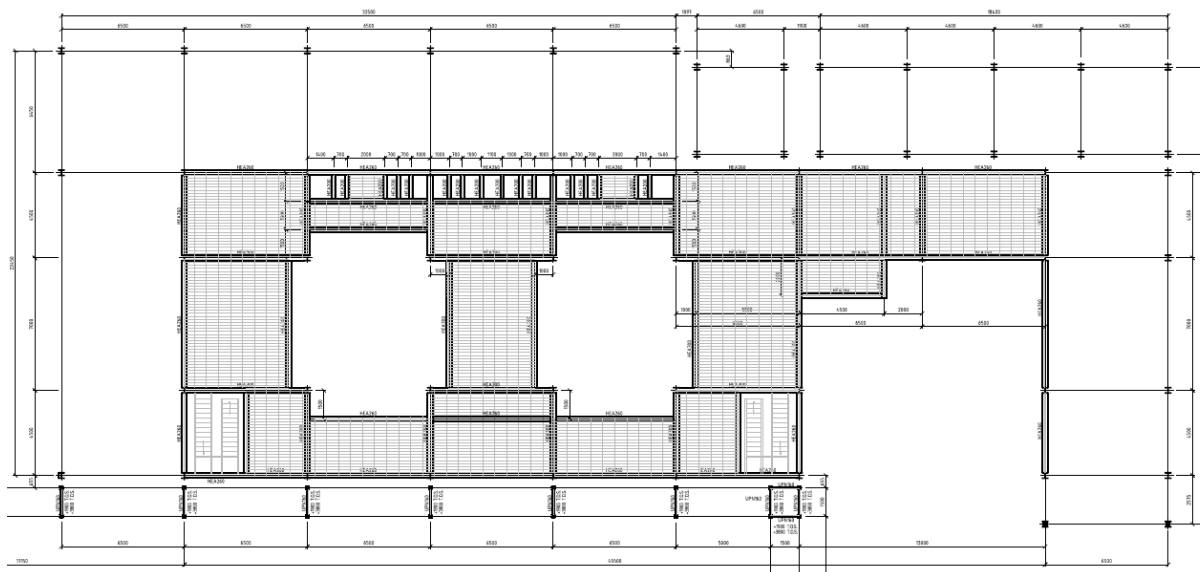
Pianta impalcato a quota +4.20m dal P.C.
